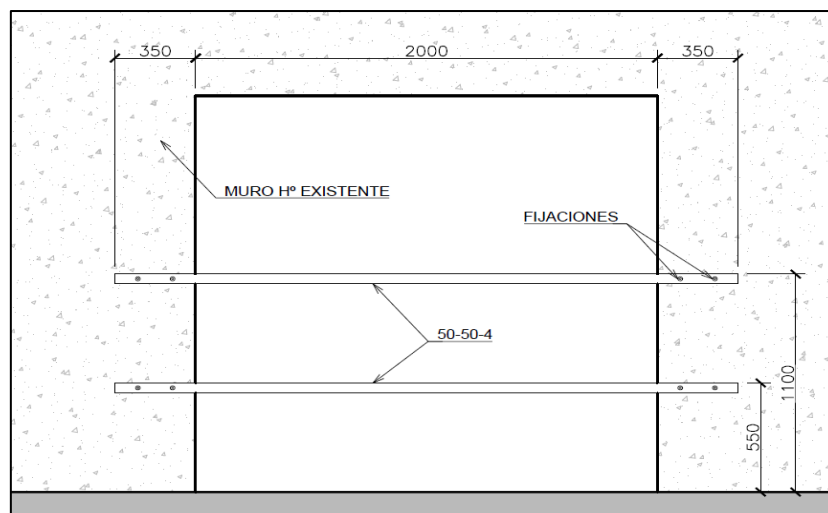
Entreplanta del Edificio SBGT, detalle de barandilla de seguridad
